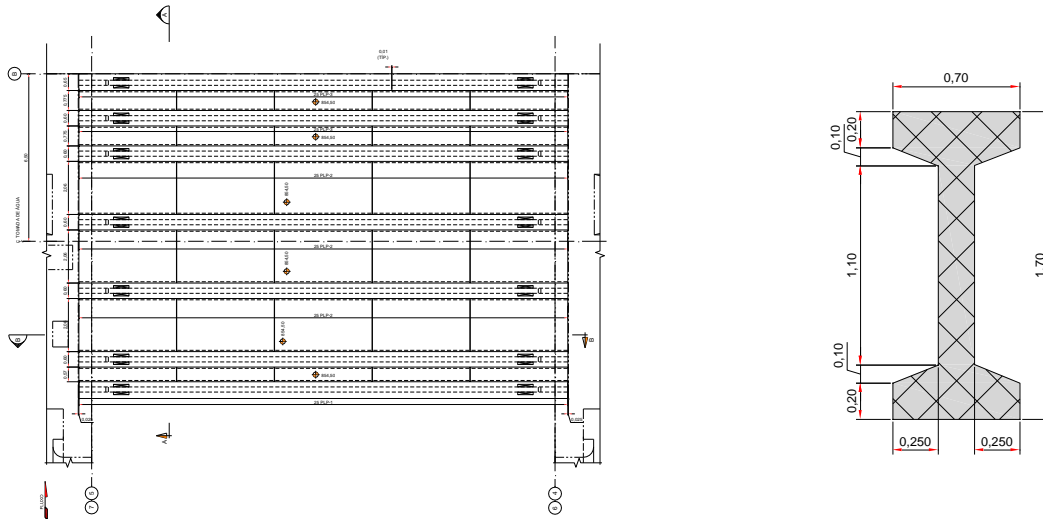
Proyecto básico- Puente entre unidades – Planta y sección de viga premoldeada (Intertechne, 2014)
